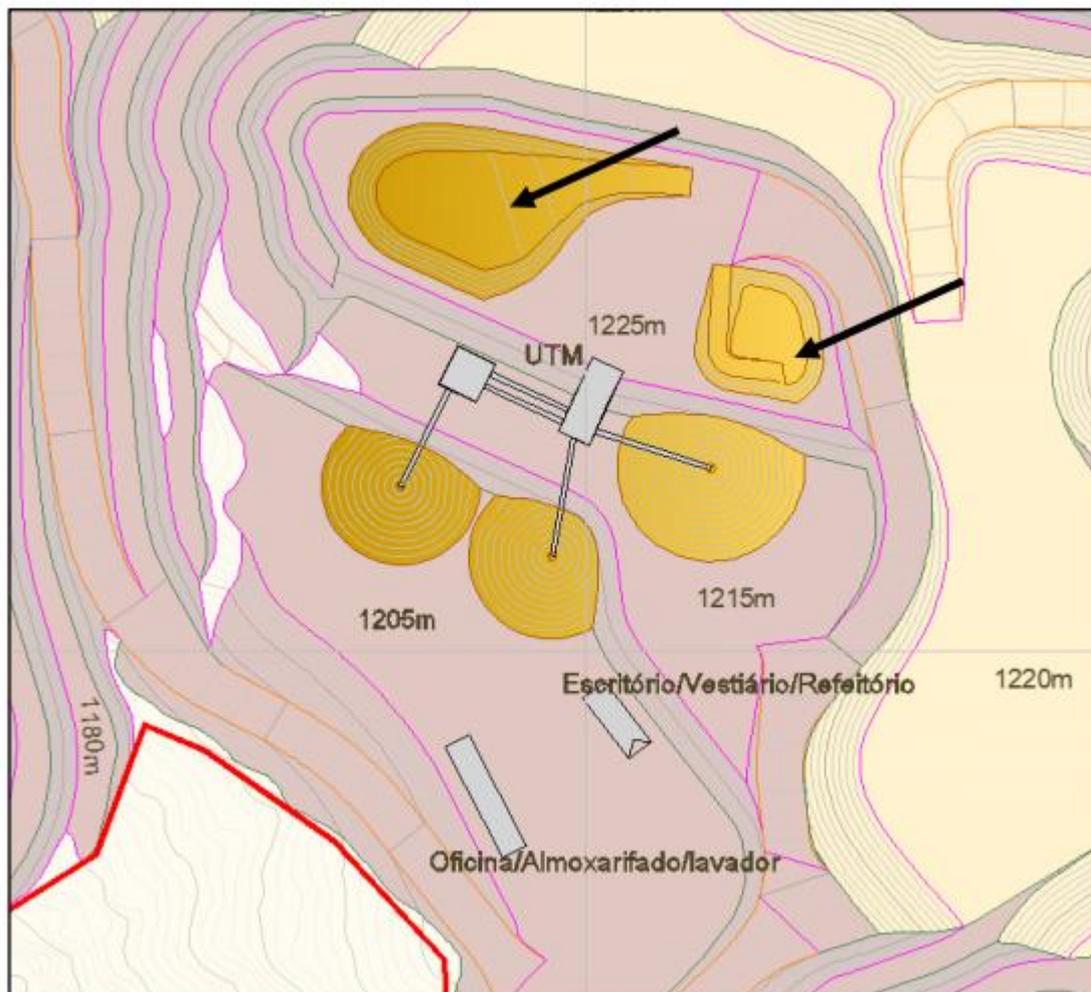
localização UTM, pátio (setas) e estruturas de apoio
